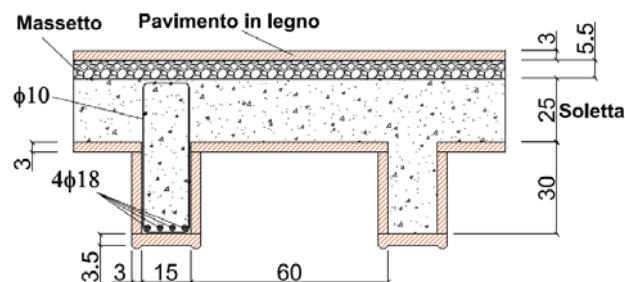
D – Sezione estratta dal report delle indagini strutturali solaio a quota 6,10 m e 11,75 m
